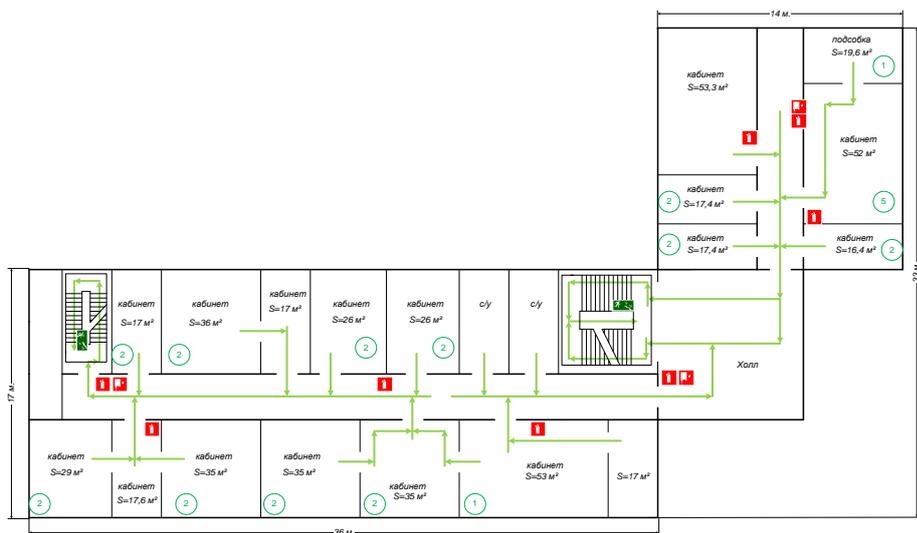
Схема эвакуации из помещений 2-го этажа
